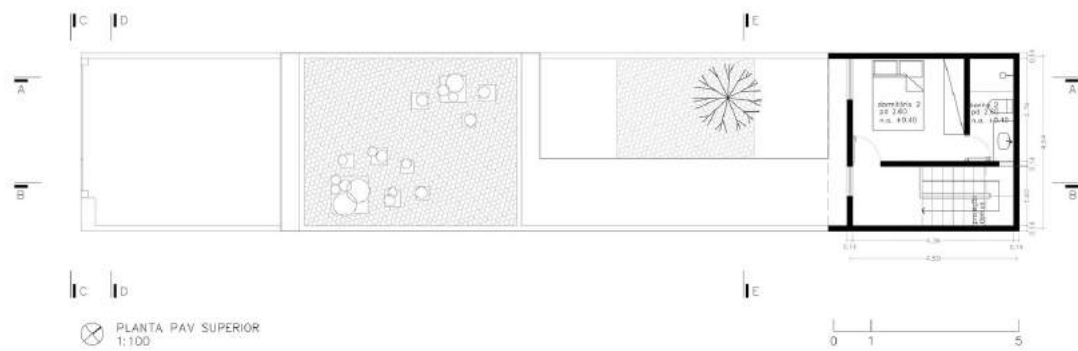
Planta “Casa Vila Matilde”: piso superior.
